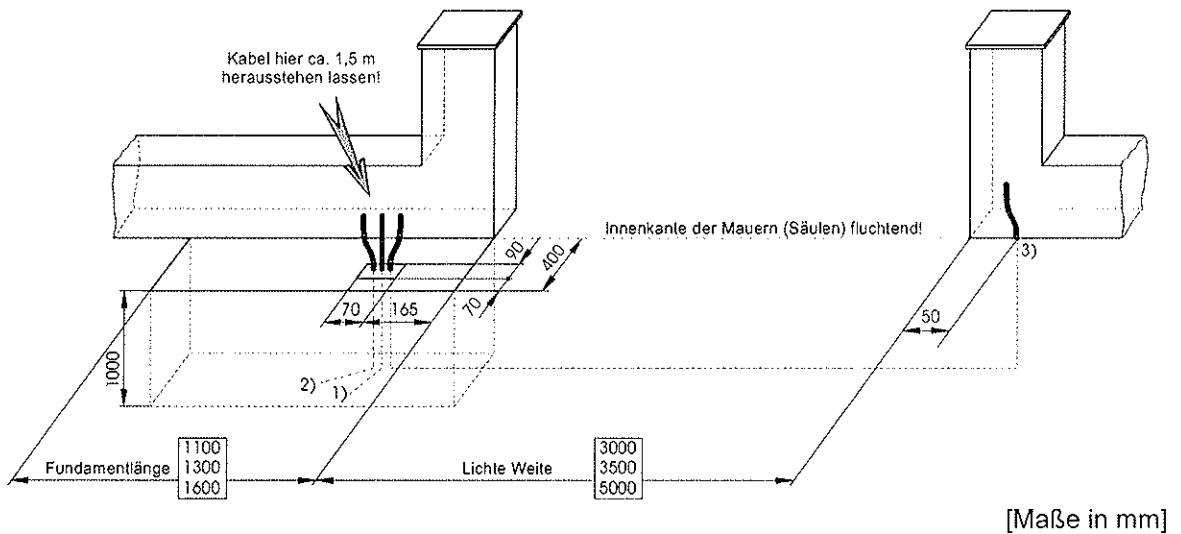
Fundamentplan SCHIEBETOR
